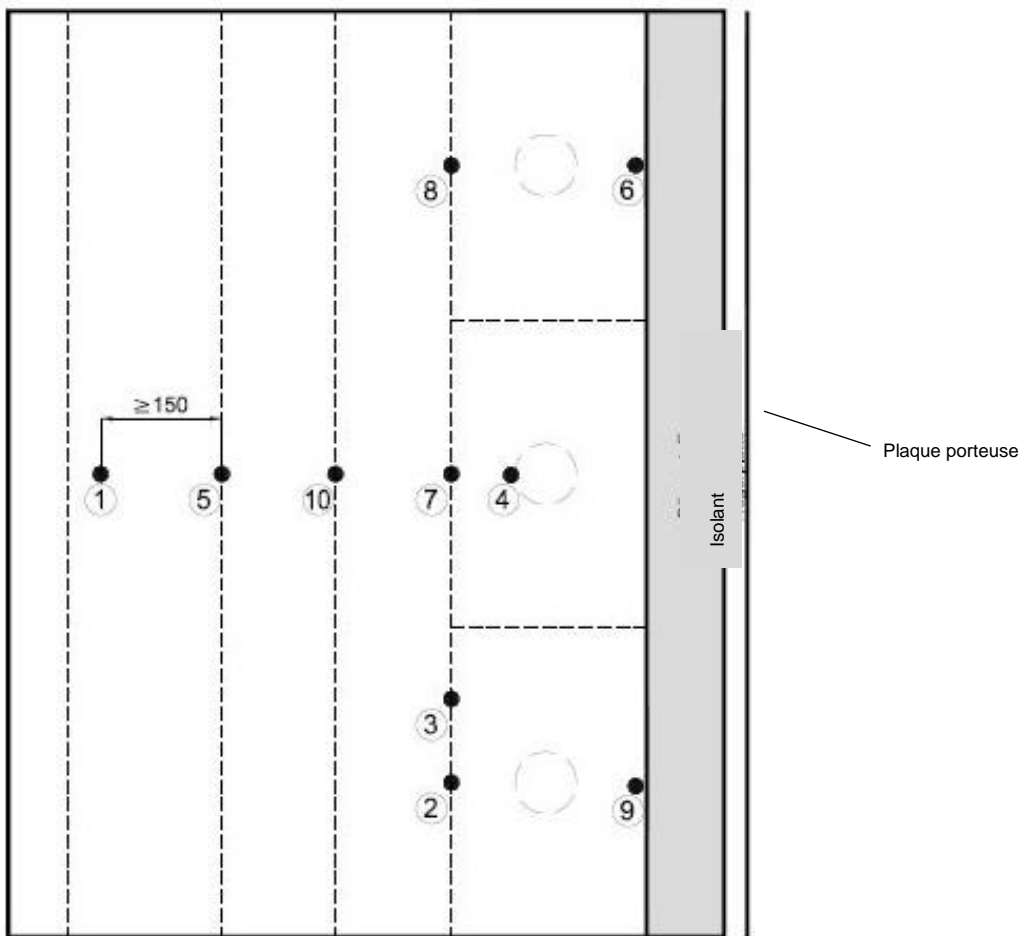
Vue en plan des points d'impact pour l'éprouvette toit plat
